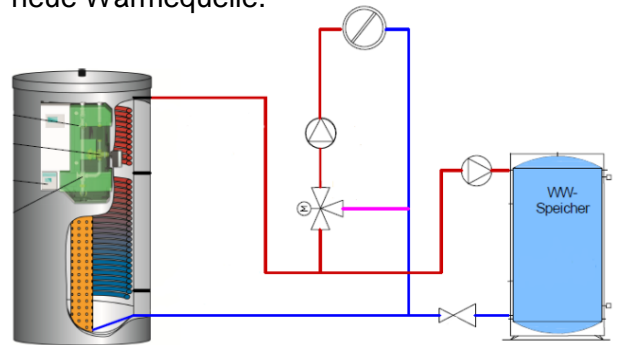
Schema einer Heizungsanlage mit Warmwasserspeicher
